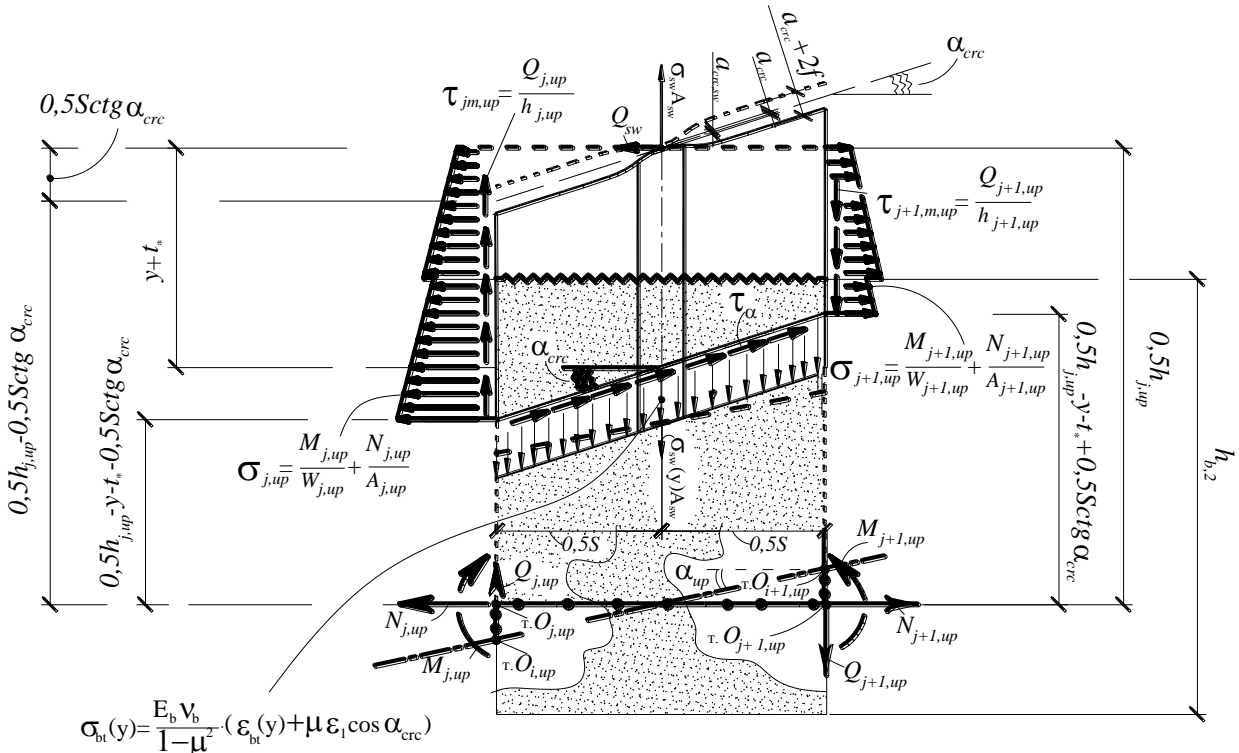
Расчетная схема второго уровня для представительного объема бетона между хомутами к определению деформаций растянутого бетона $\varepsilon_{bt}(y)$ вдоль оси поперечной арматуры на i -ом уровне образования наклонных трещин первого, второго или третьего типа
